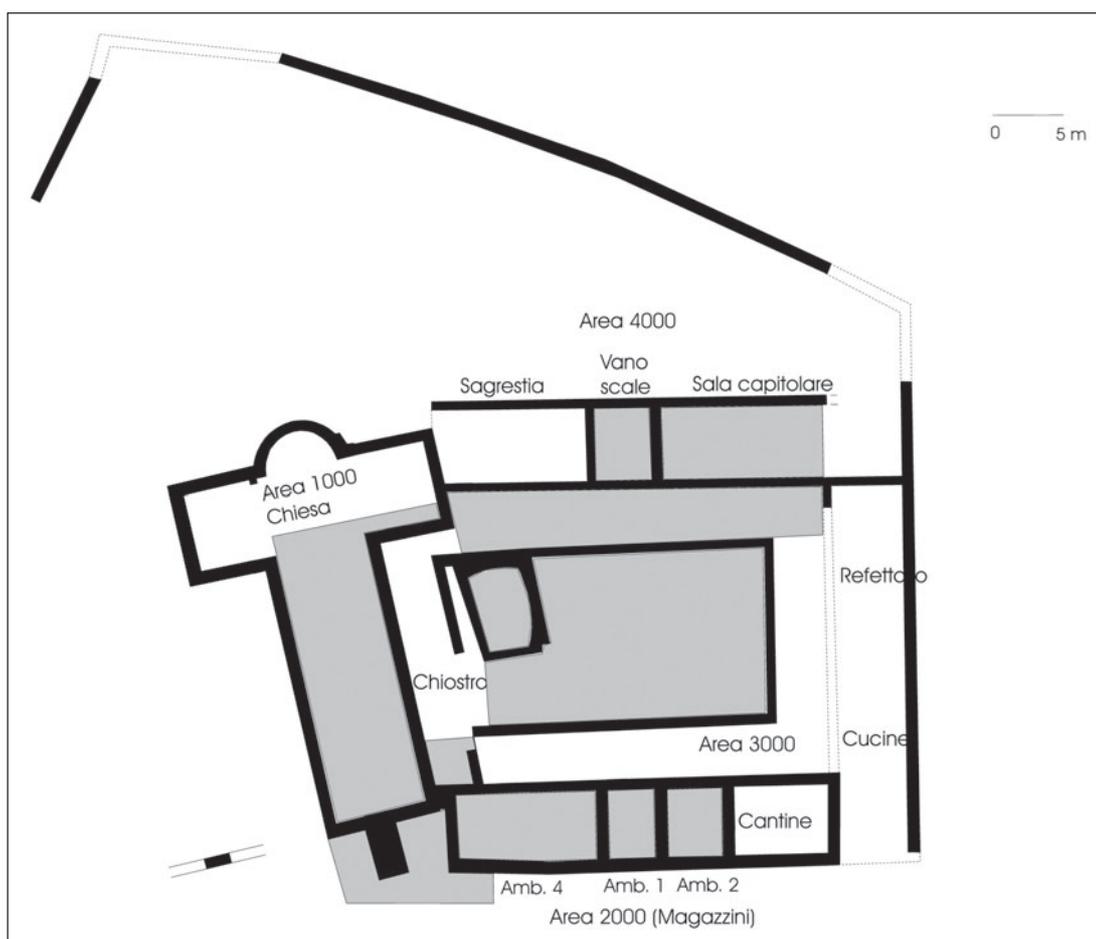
Planimetria generale. Aree scavate (in grigio).
